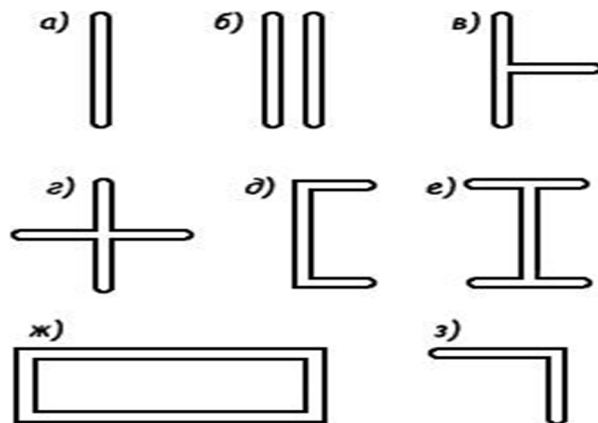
Поперечні перерізи щілинних фундаментів: а - прямокутний;
